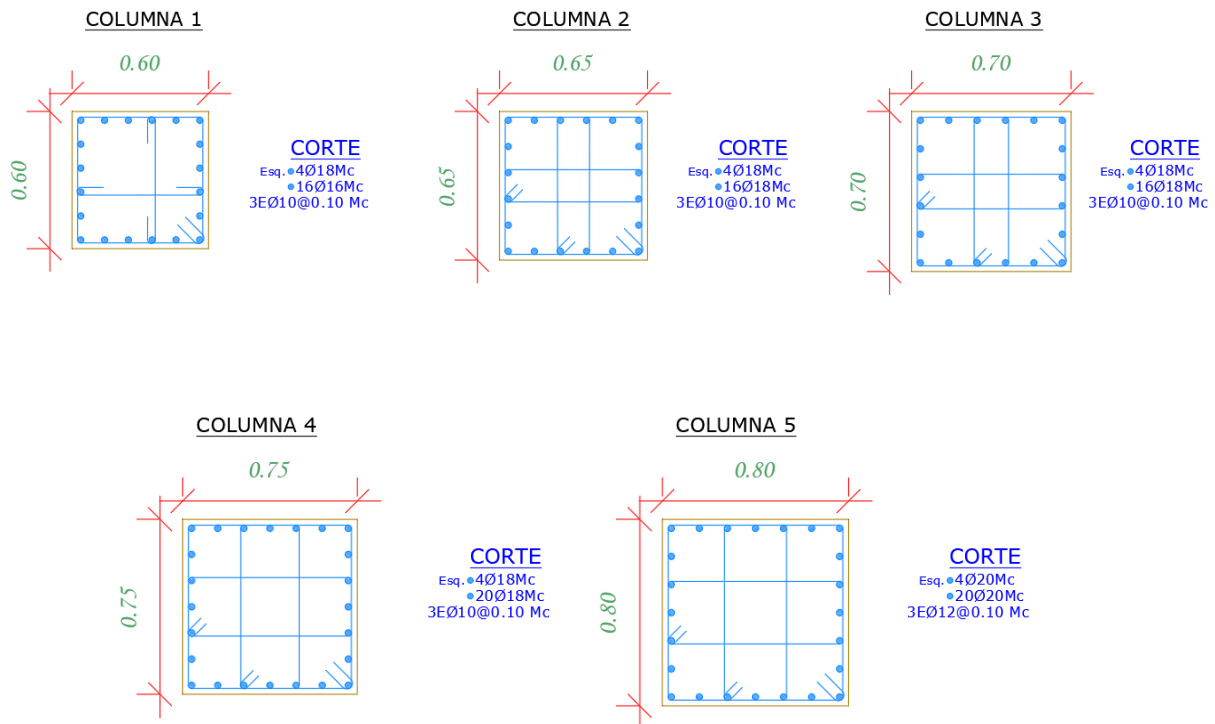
Sección transversal de la columna utilizada en un edificio de 6 pisos.
